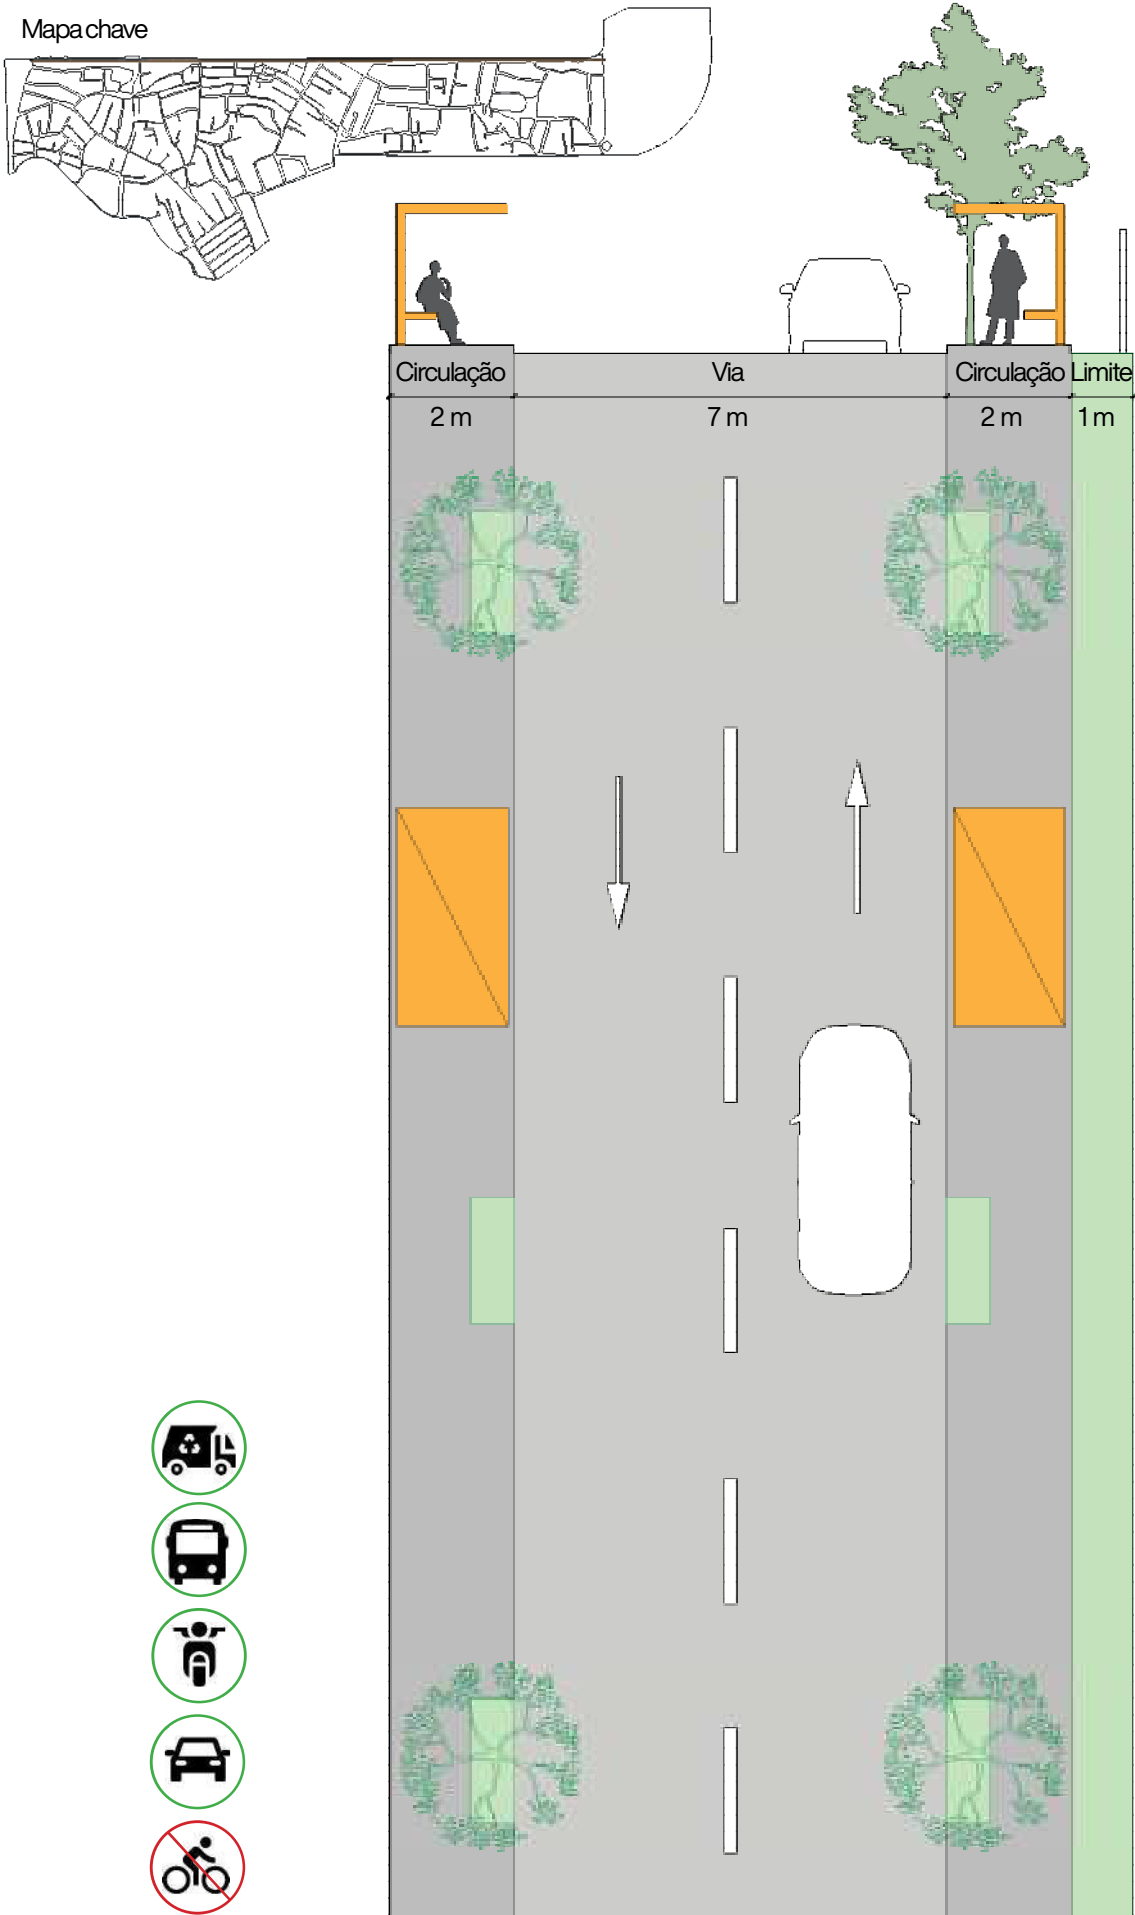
Planta e corte da DF 097 - Estrada Parque Acampamento (EPAC)
